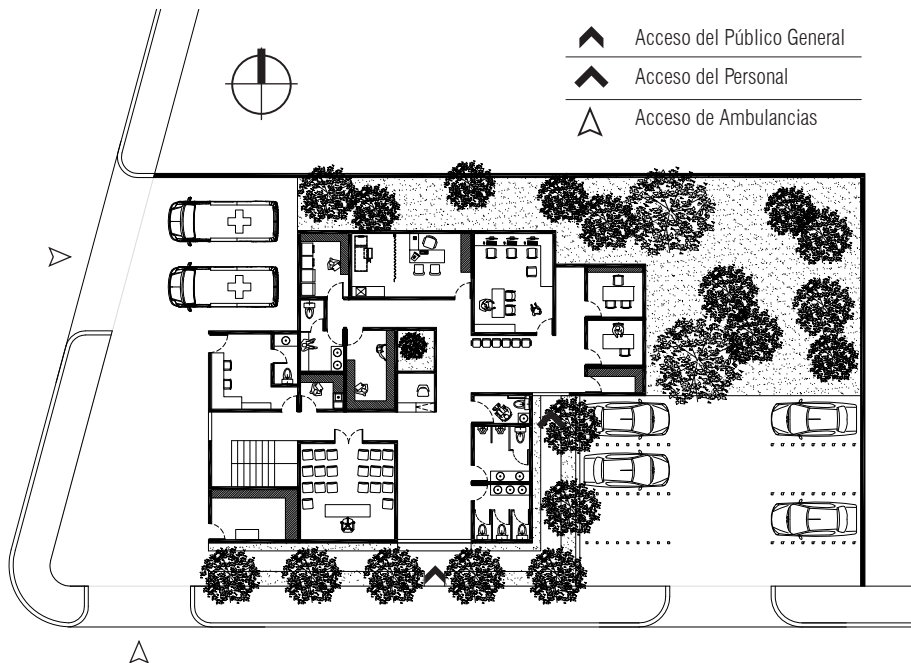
| Prototipo Delegación Básica para el grupo climático dos | Planta Baja
